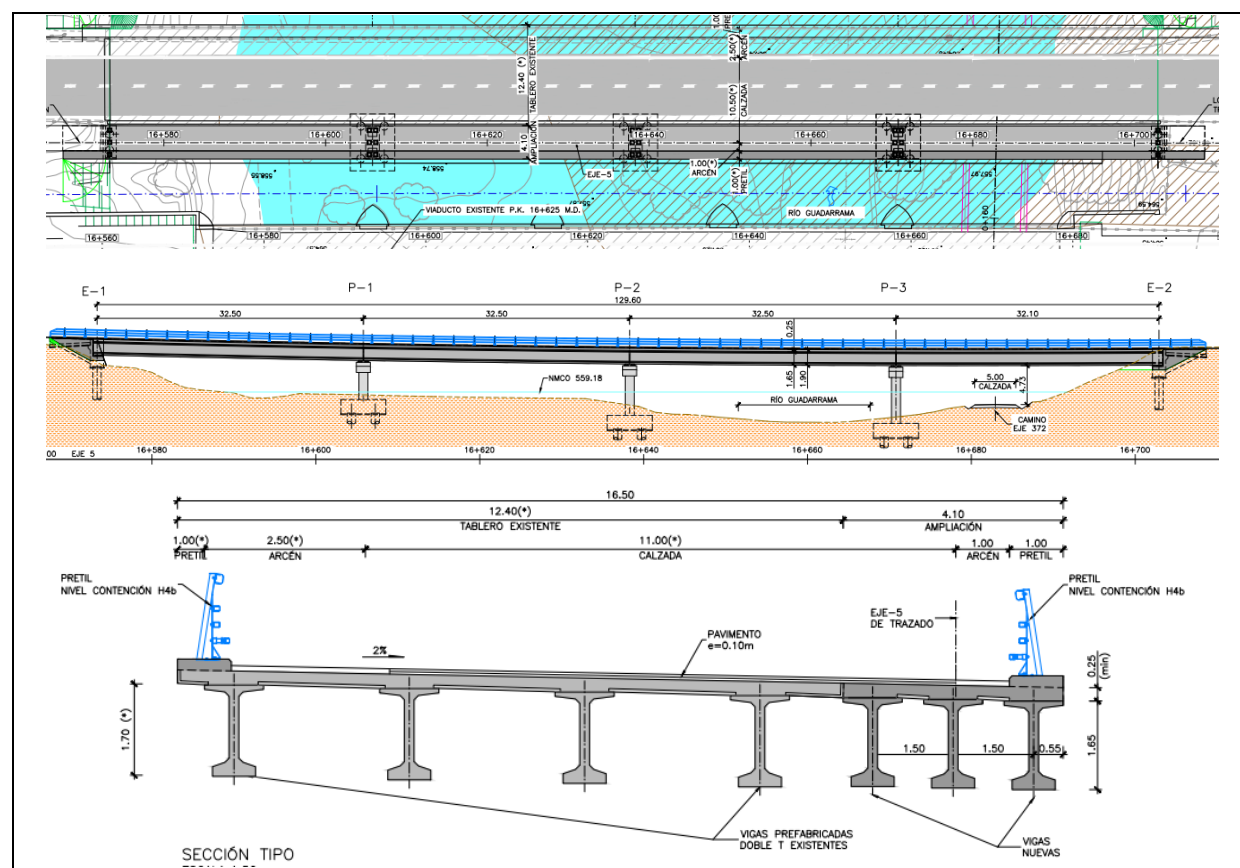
Viaducto 16+625 VS MD proyectado. Planta y alzado
